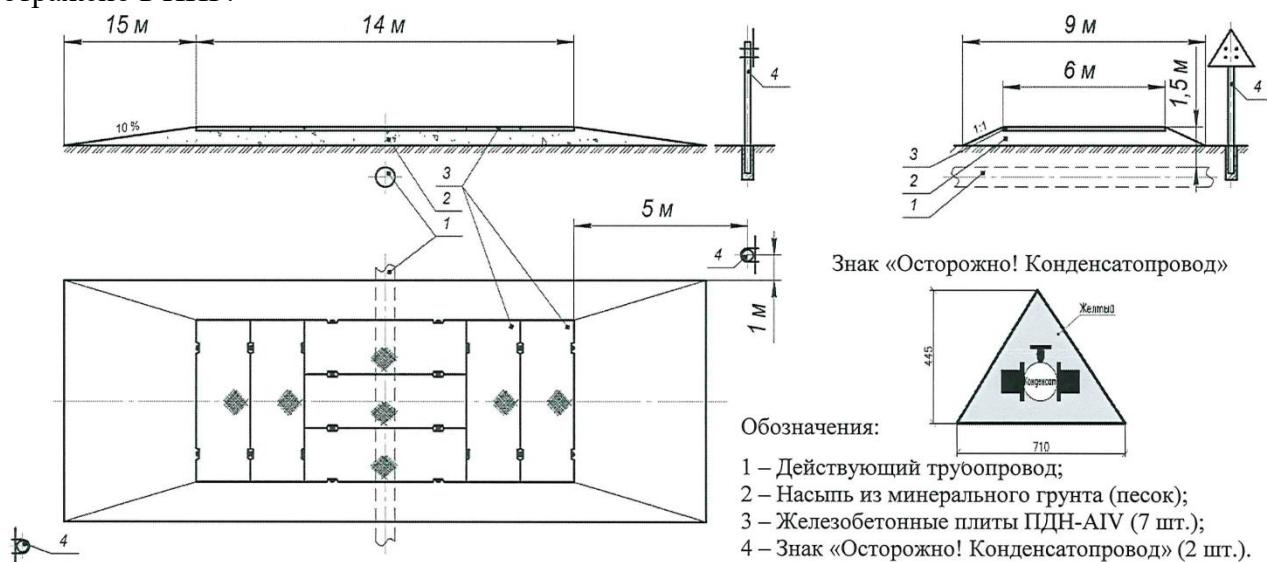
Схема конструкции временного переезда через действующий трубопровод с применением железобетонных плит
